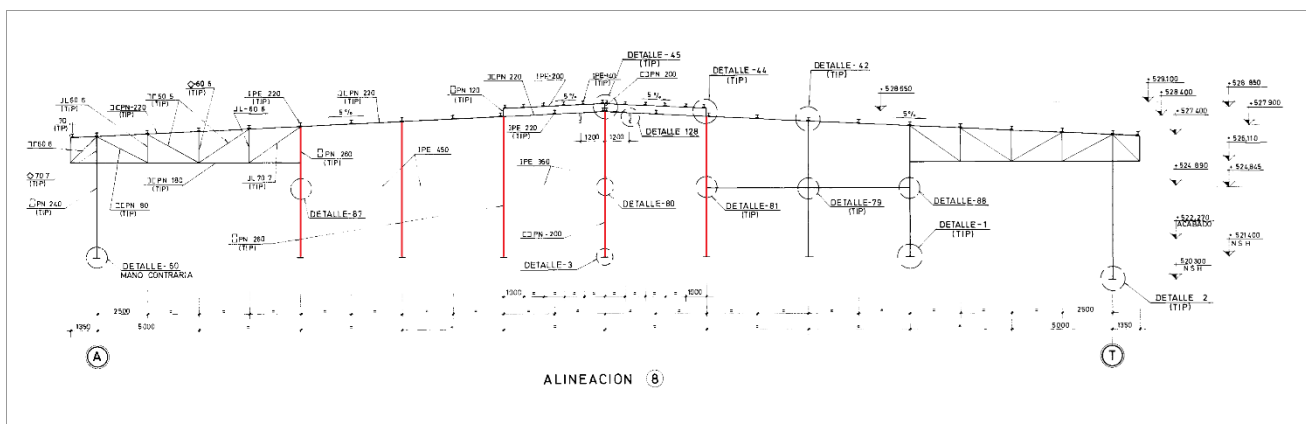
Estructura metálica – Modificación del pórtico en alineación 8
